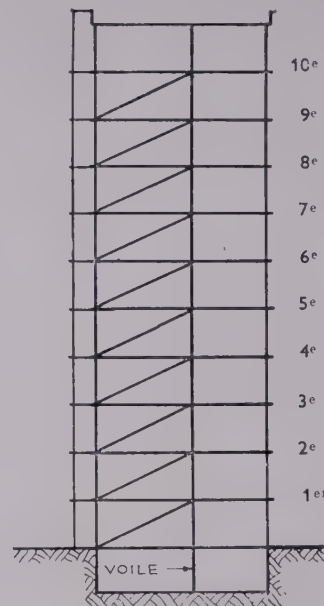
Coupe sur la poutre triangulée de contreventement.
